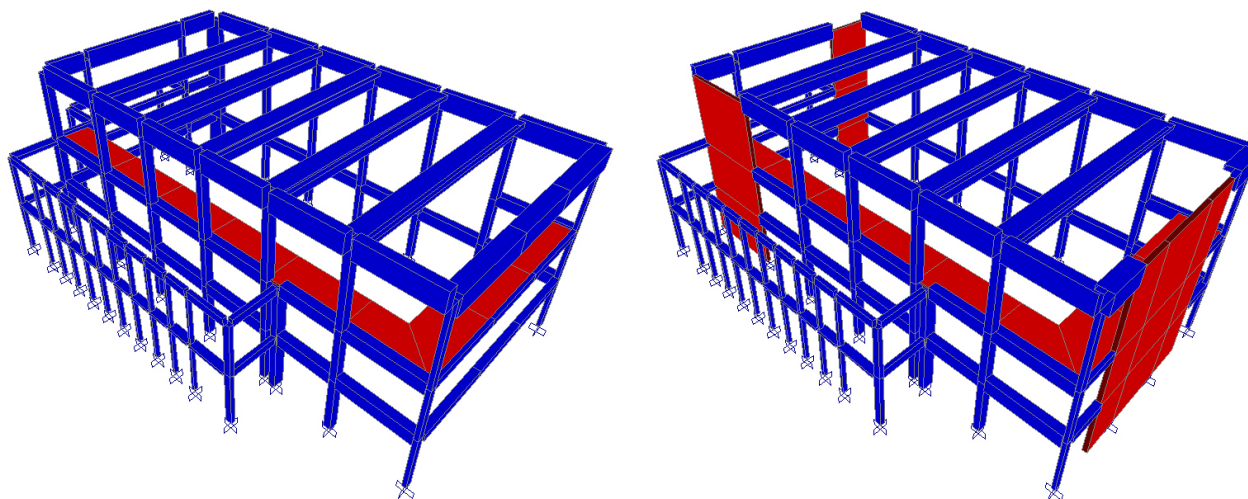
modello strutturale della piscine senza setti e con l'inserimento dei setti di cemento armato.
